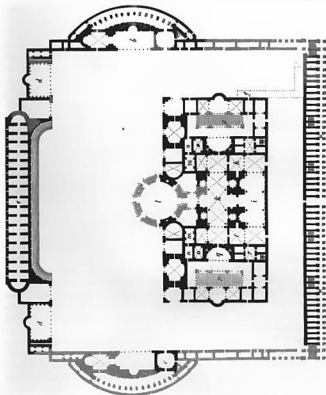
Grundriss der Thermen des Caracalla.
